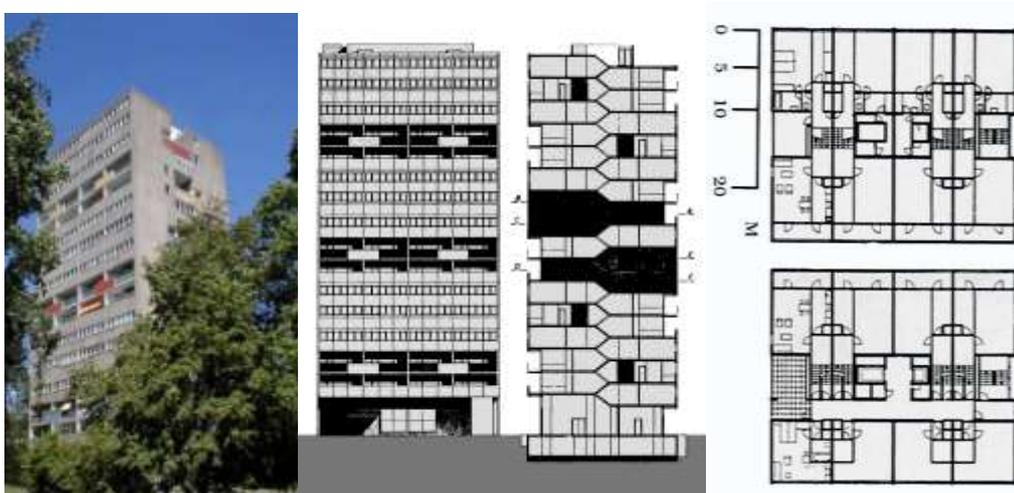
Vista exterior do bloco de apartamentos da Torre van den Broek/Bakema (Disponível em: <http://www.berliner-hansaviertel.de/broek.htm>); alçado, secção vertical e plantas (SHERWOOD, 1983).
